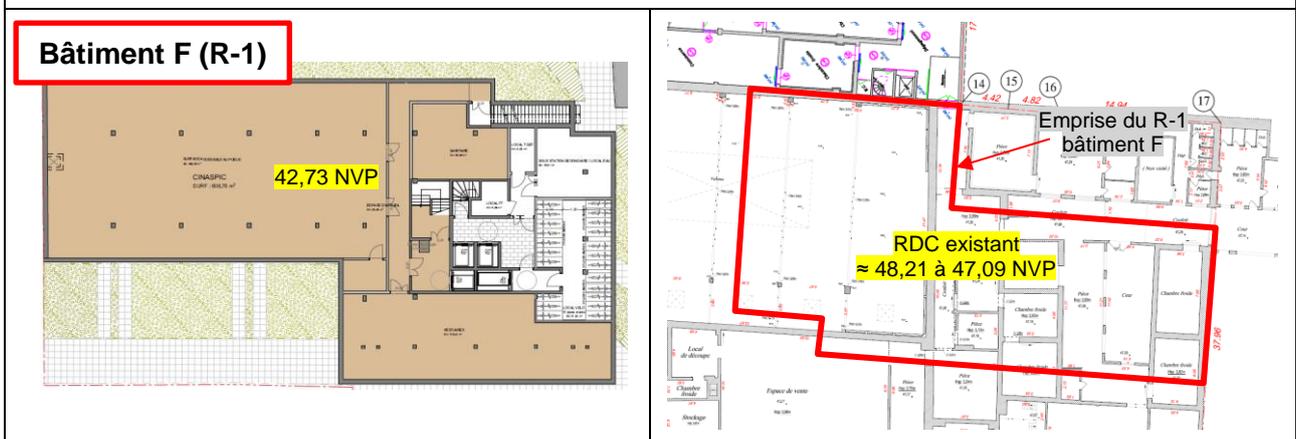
Extrait du plan du R-1 du bâtiment F, datés du 16/11/2023 et extrait du plan RDC existant, du 12/04/2023
